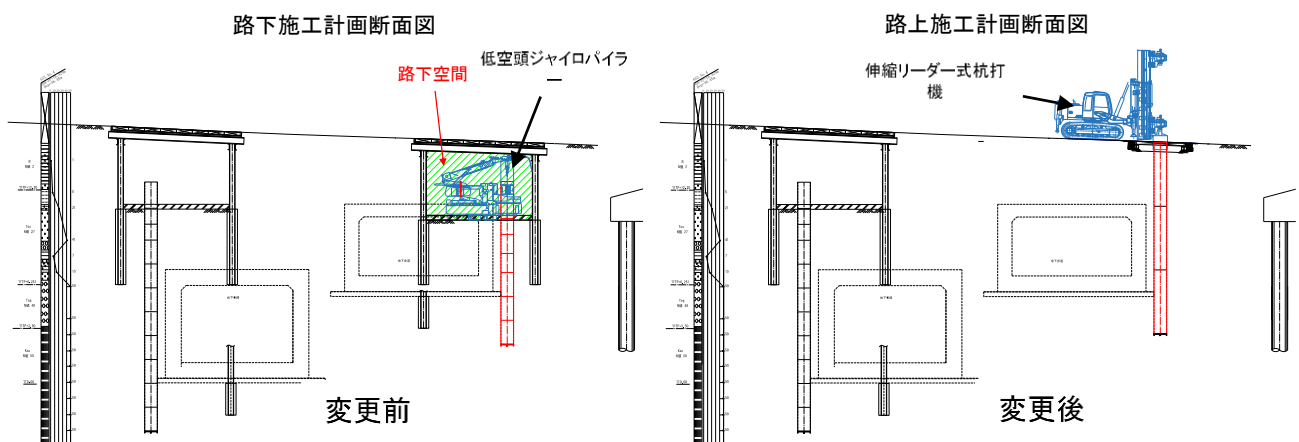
仮設計画の変更 左：当初施工計画（路下施工） 右：変更施工計画（路上施工）
